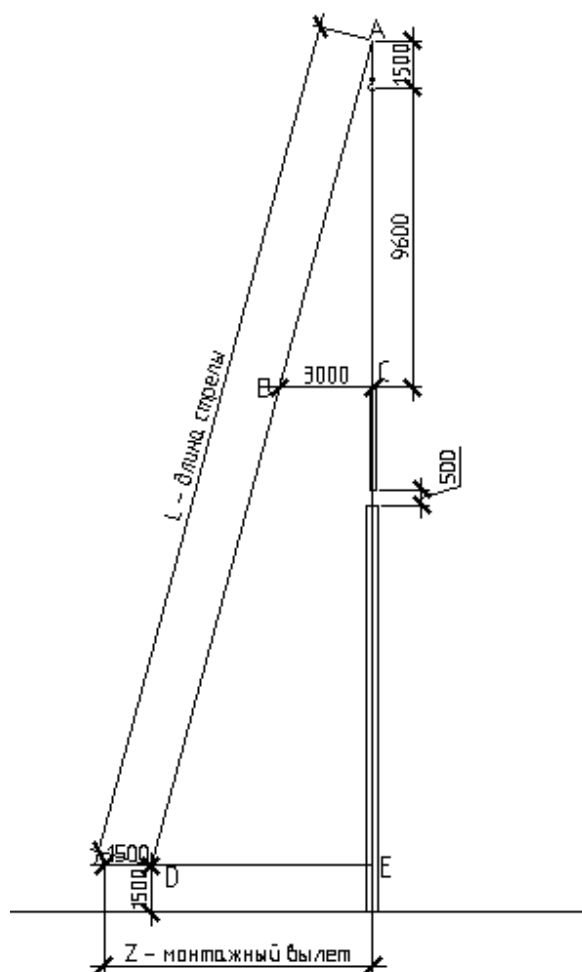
Схема к выбору крана для монтажа ферм покрытия
